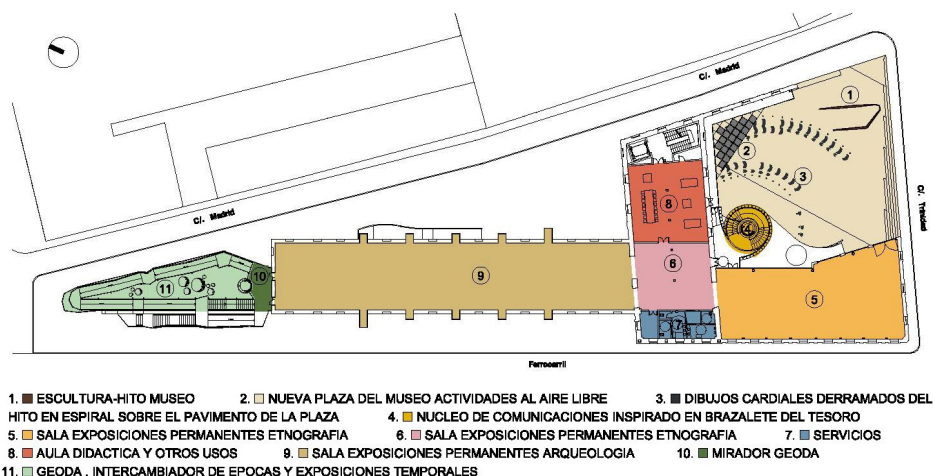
Planta primera del museo. Fuente: Elaboración propia.
